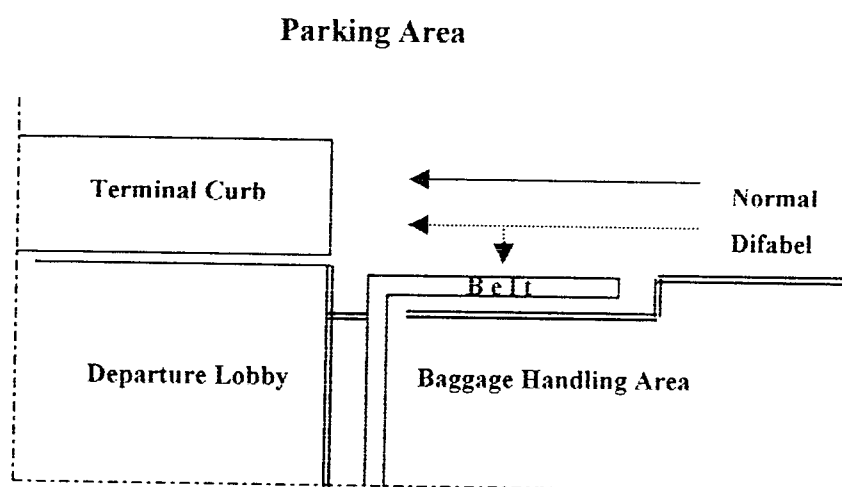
Lokasi Ramp di Ruang Khusus Dalam Terminal
